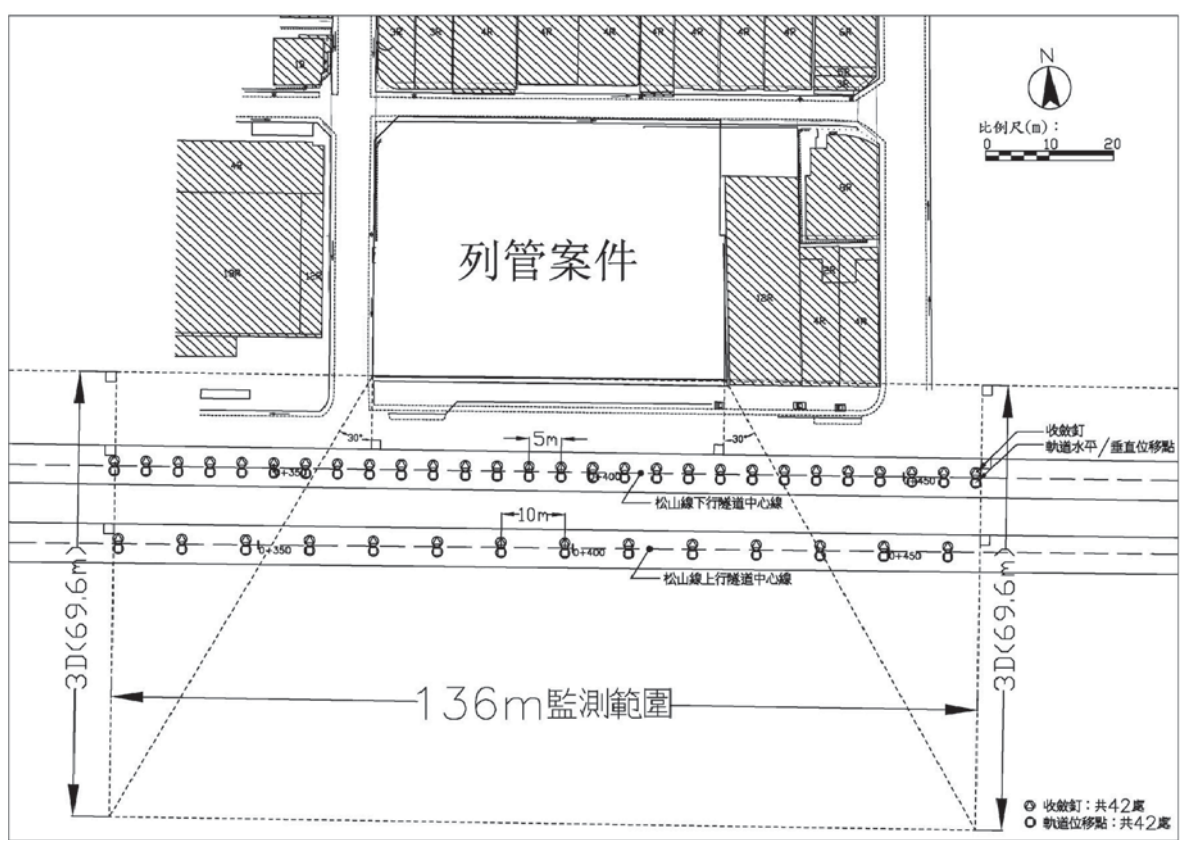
捷運設施監測儀器佈設範圍及儀器配置平面圖 A16-14
